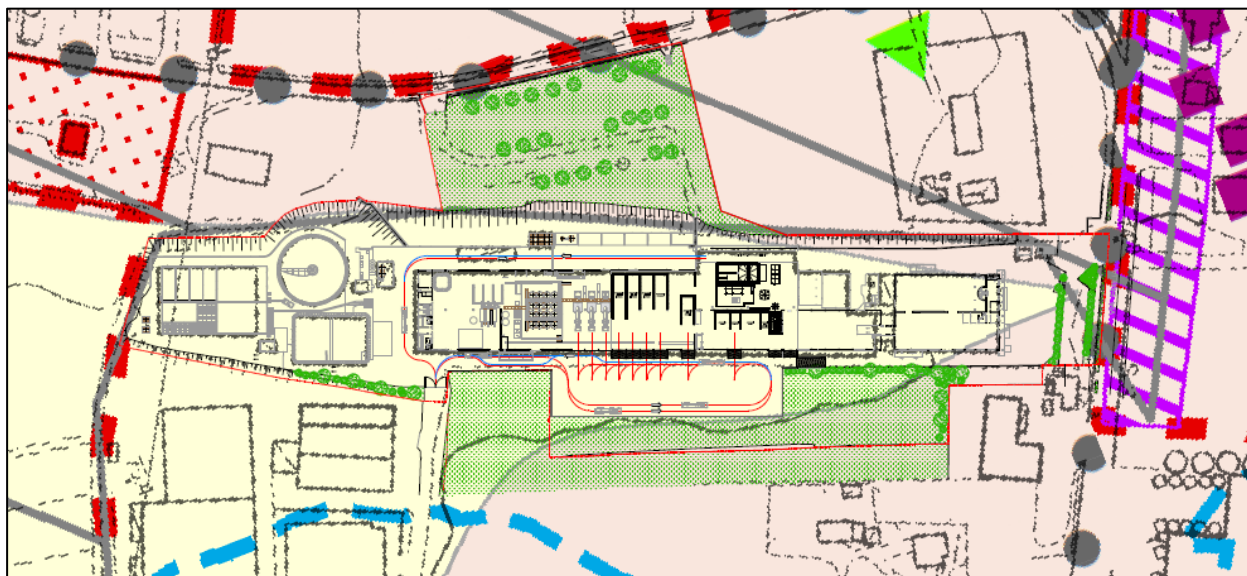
Sovrapposizione della planimetria di progetto alla Tavola 2 del PSC
